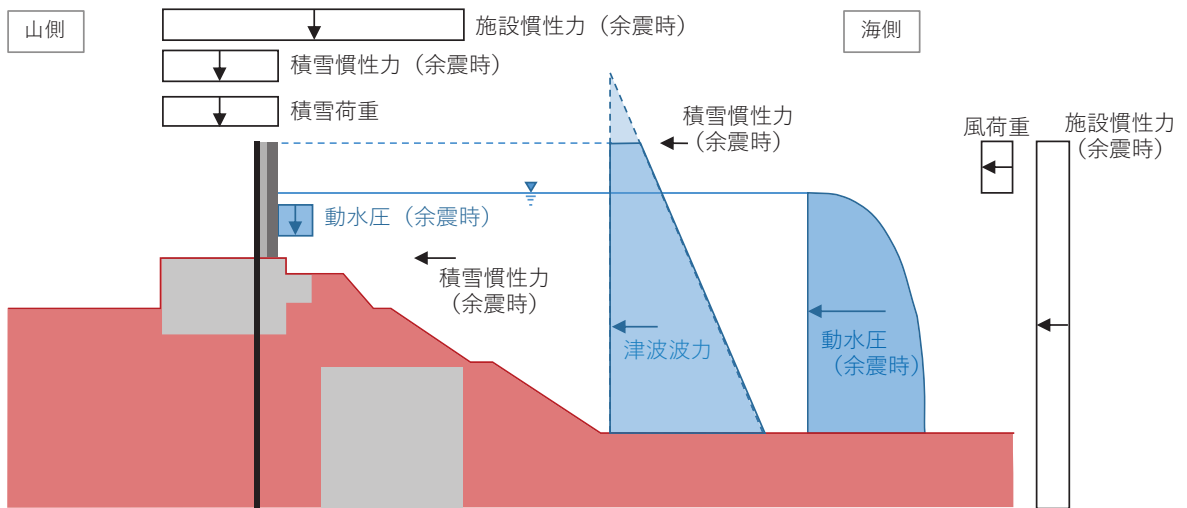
津波荷重+余震荷重による構造物に作用する水平力のイメージ図
